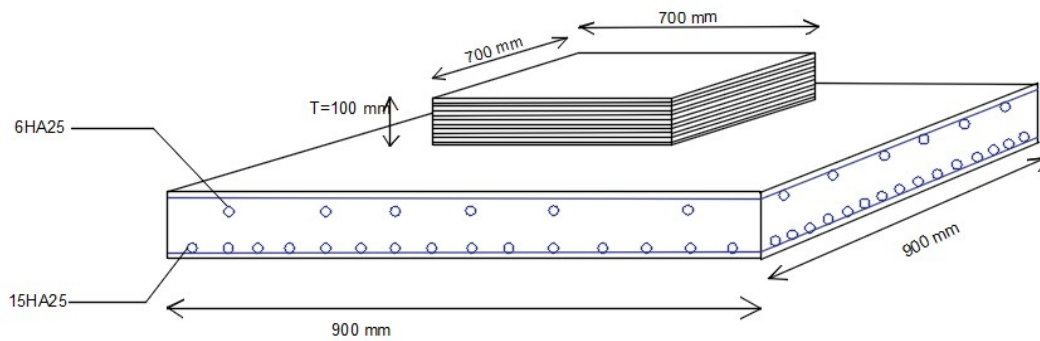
Détail de Ferrailage du dé d'appui à la pile et positionne de l'appareil d'appui
